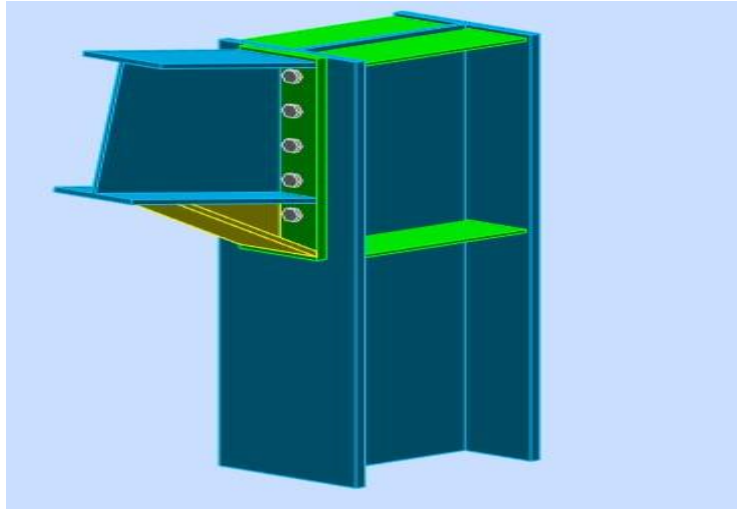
Vue 3D de l'assemblage poteau-traverse
